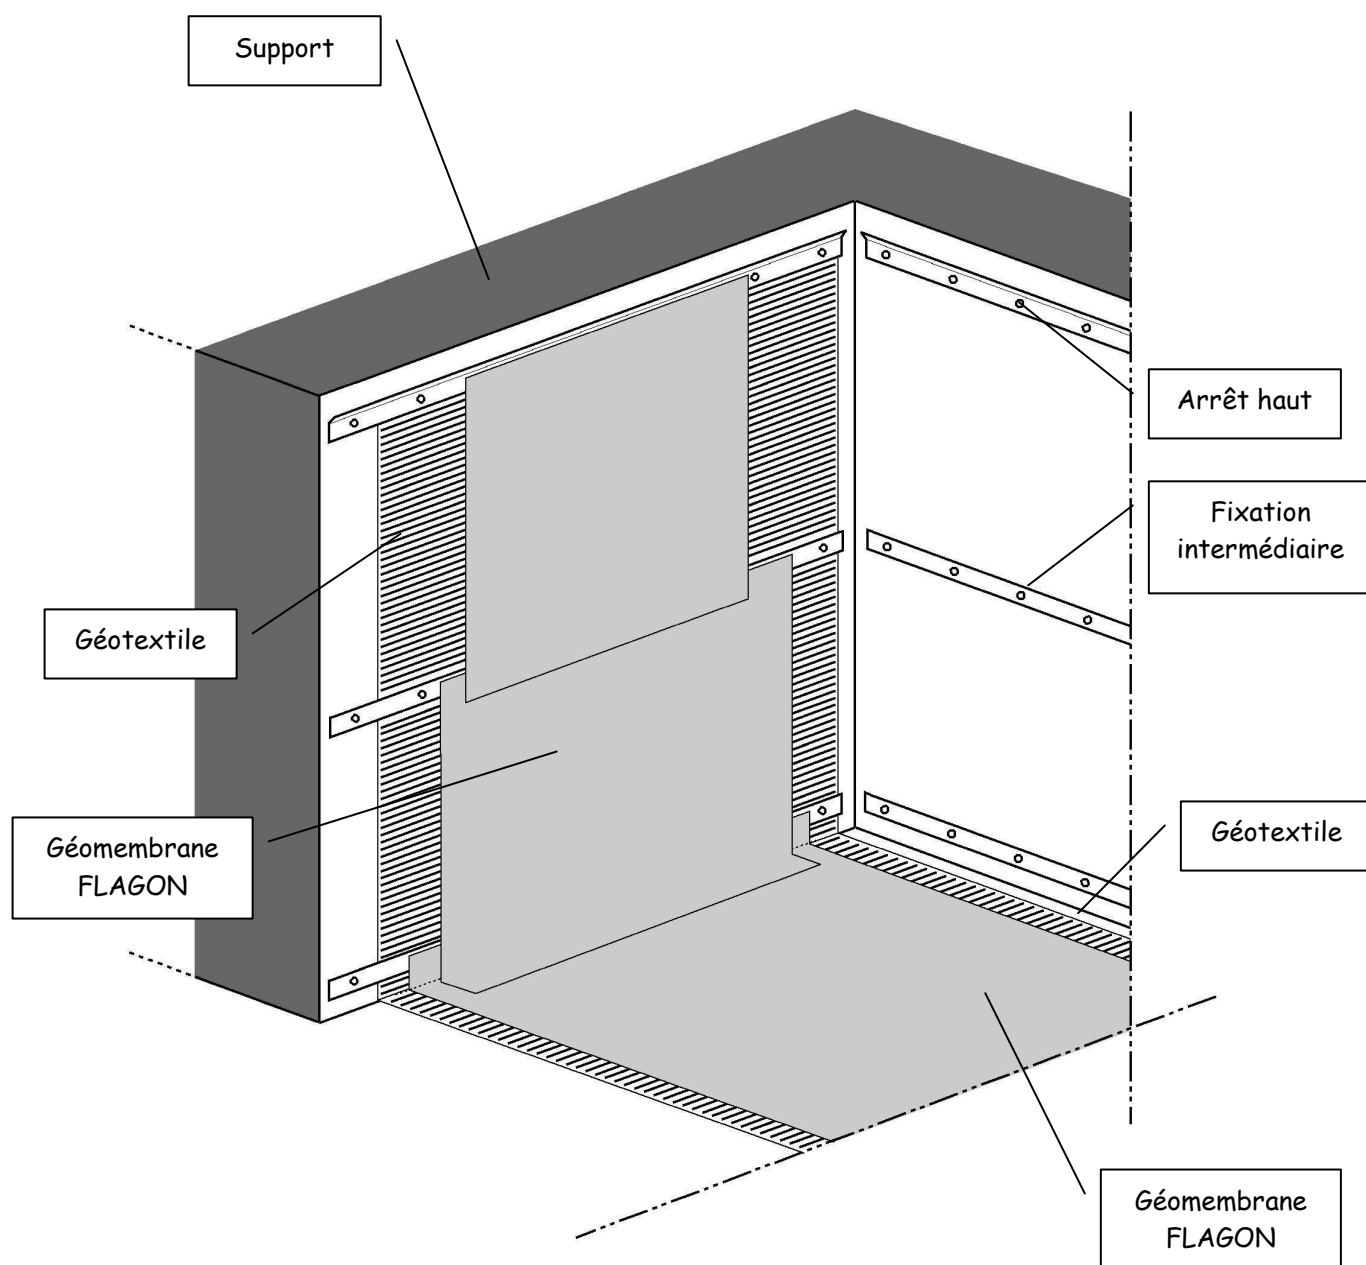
Fixation horizontale sur ouvrage béton
